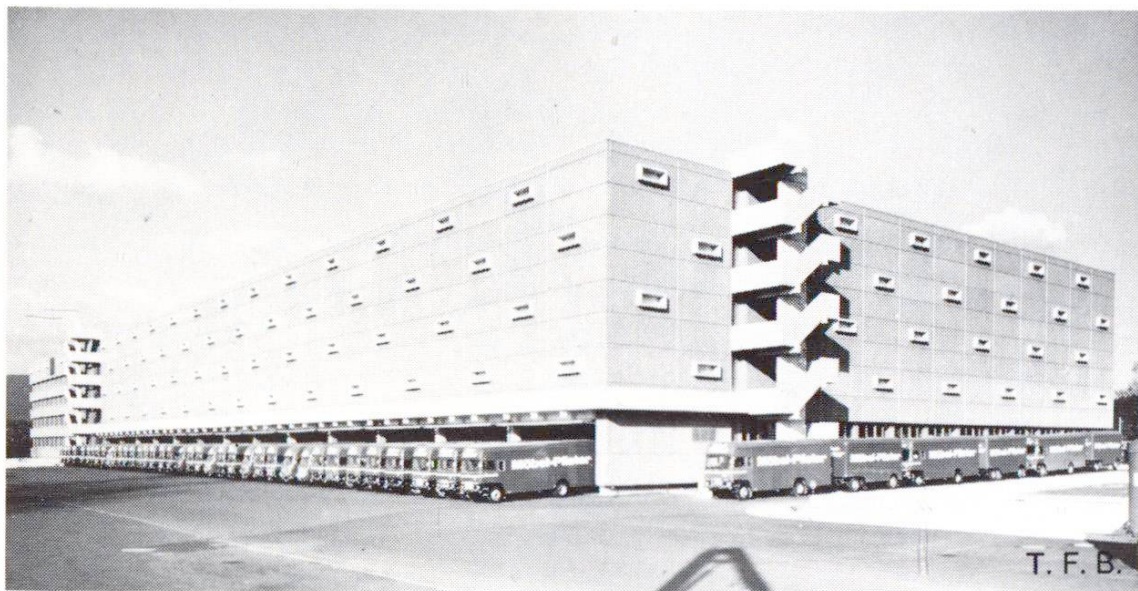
Dépôt de meubles à Suhr. Dalles préfabriquées en béton lavé.
